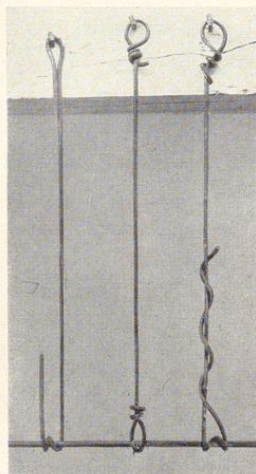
Richtig geschlossene Abhänger und richtiger Hakeneinschlag
